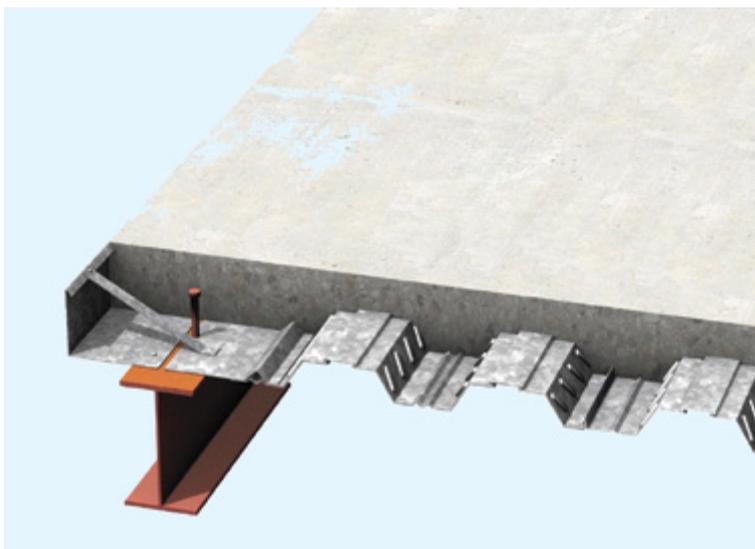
Сталежелезобетонное перекрытие с профилированным настилом, работающим совместно с плитой.
